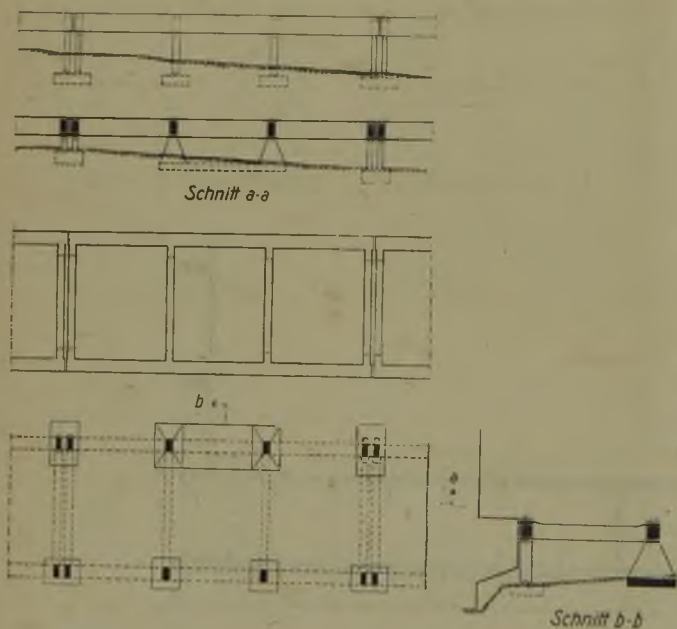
Maschinenbahn einer Koksaustrückmaschine.
